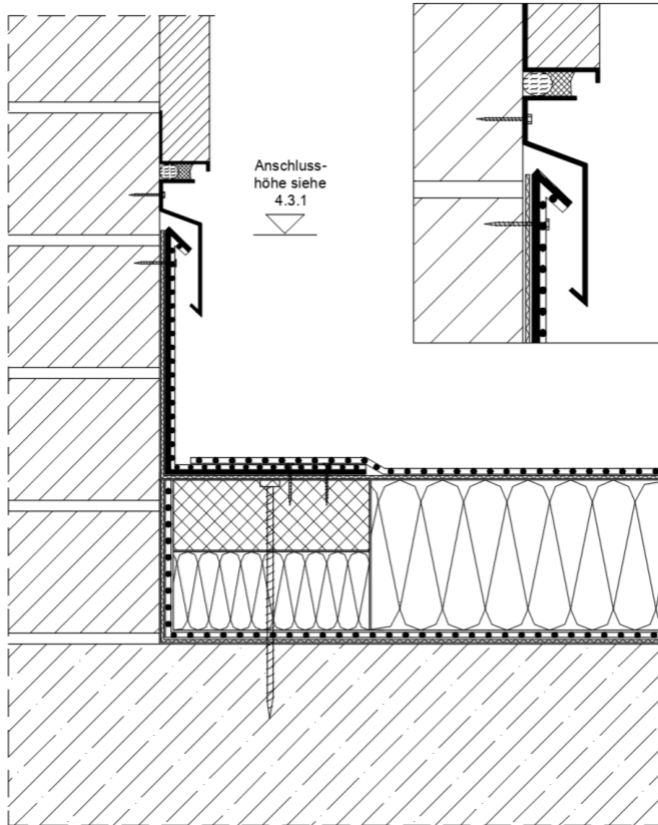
Starrer Wandanschluss mit Kunststoffbahnen und Linienbefestigung – gedämmte Wand mit Wärmedämmverbundsystem
